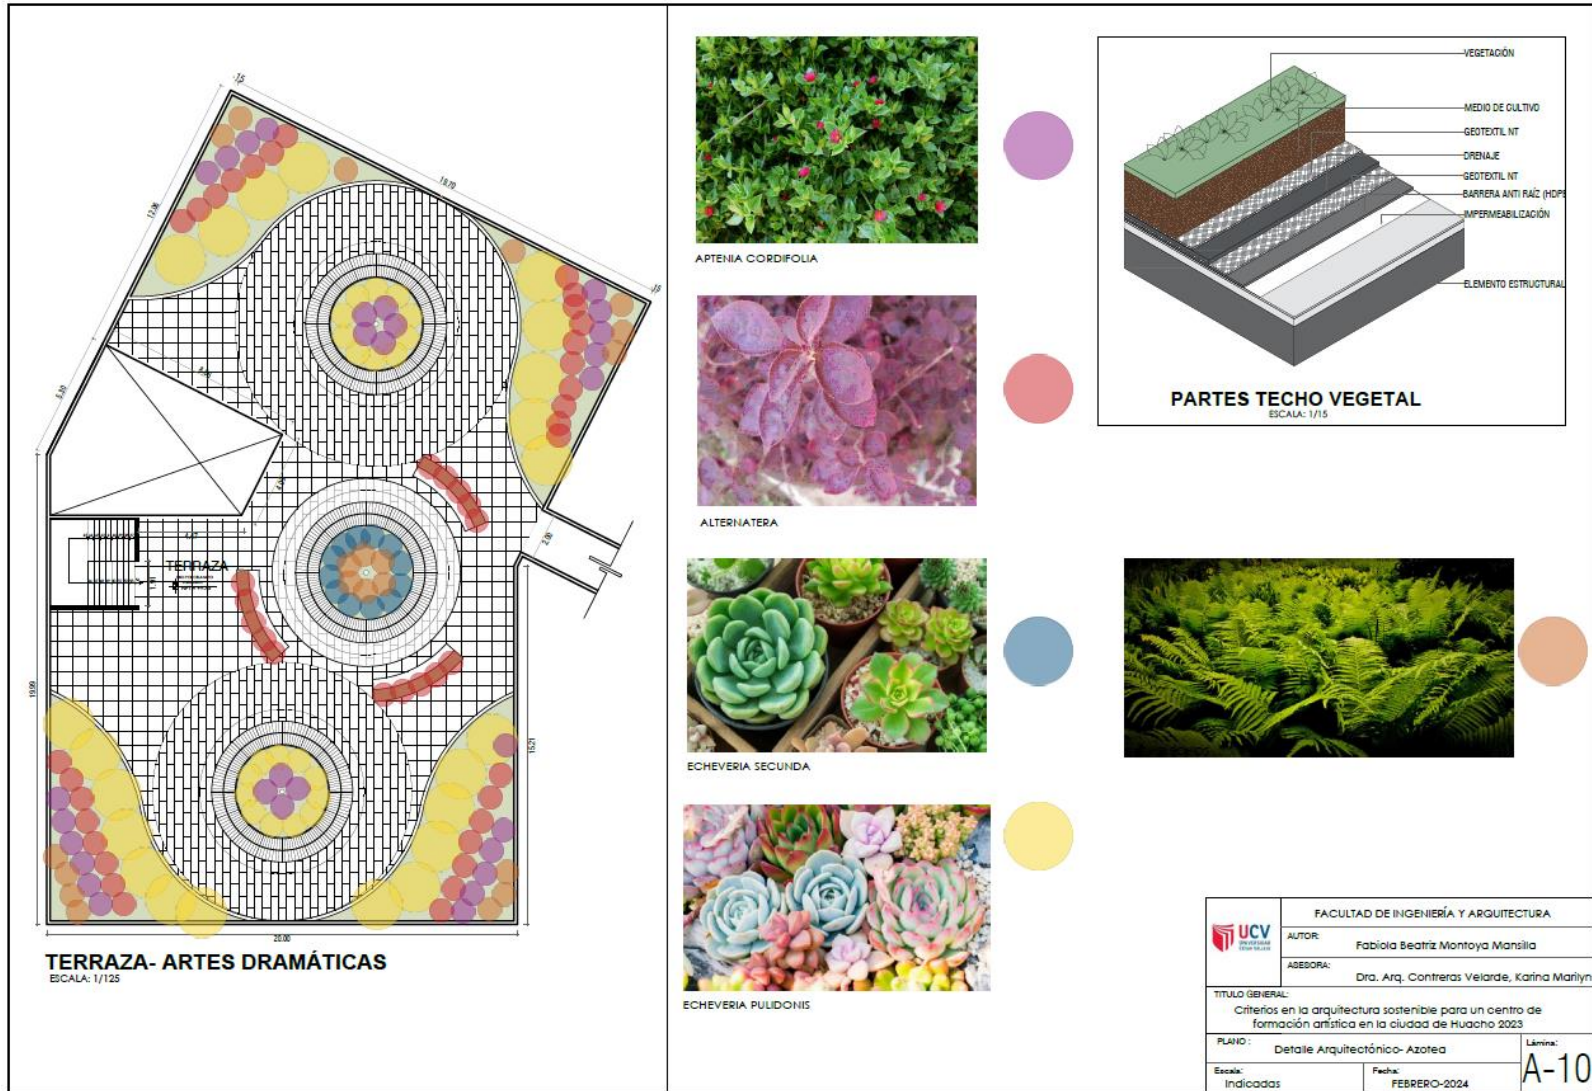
Plano de Detalles Arquitectónicos 1, Azotea de Escuela de Arte Dramático
